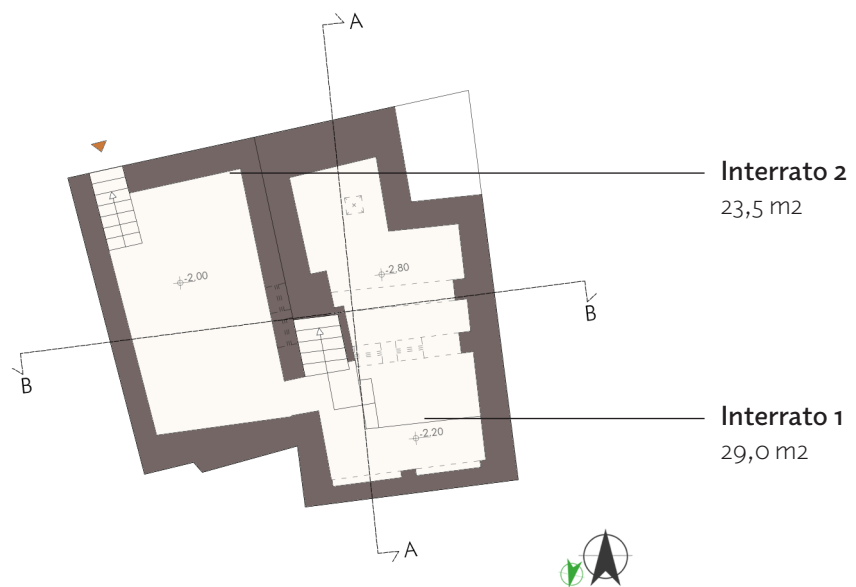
Pianta del piano interrato. Scala 1/200
